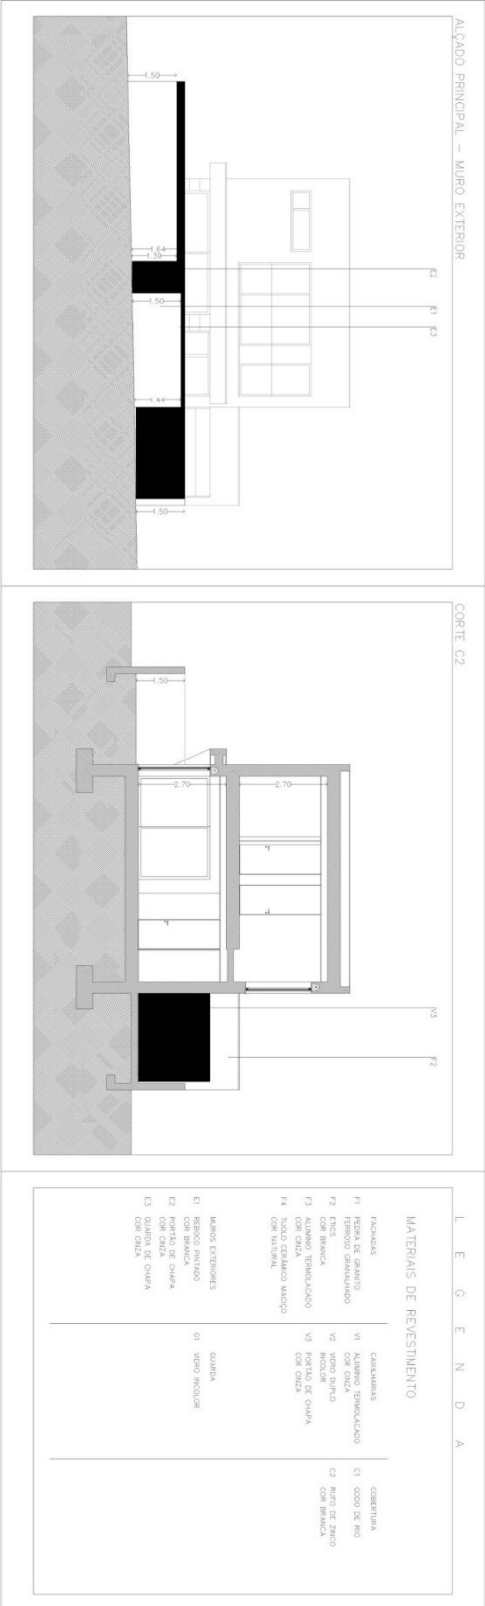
Alçado Principal - Muro exterior e Corte C2
